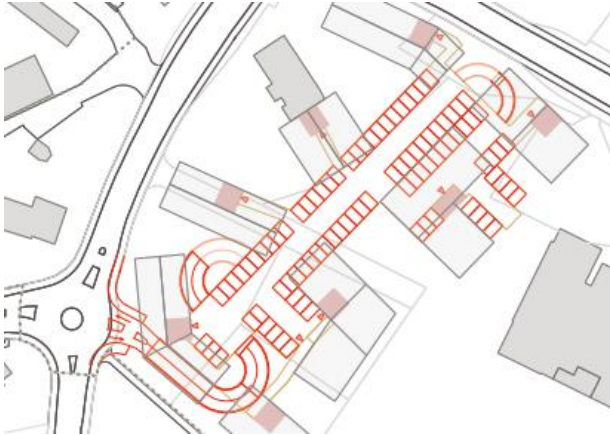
Erschliessung und Parkierung unterirdisch, 1. UG
